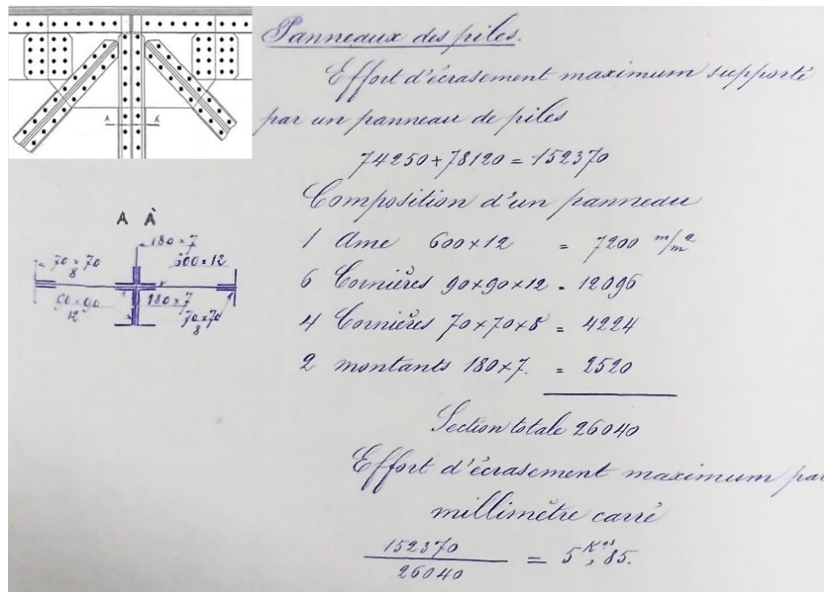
Cálculo da compressão máxima suportada por um montante
